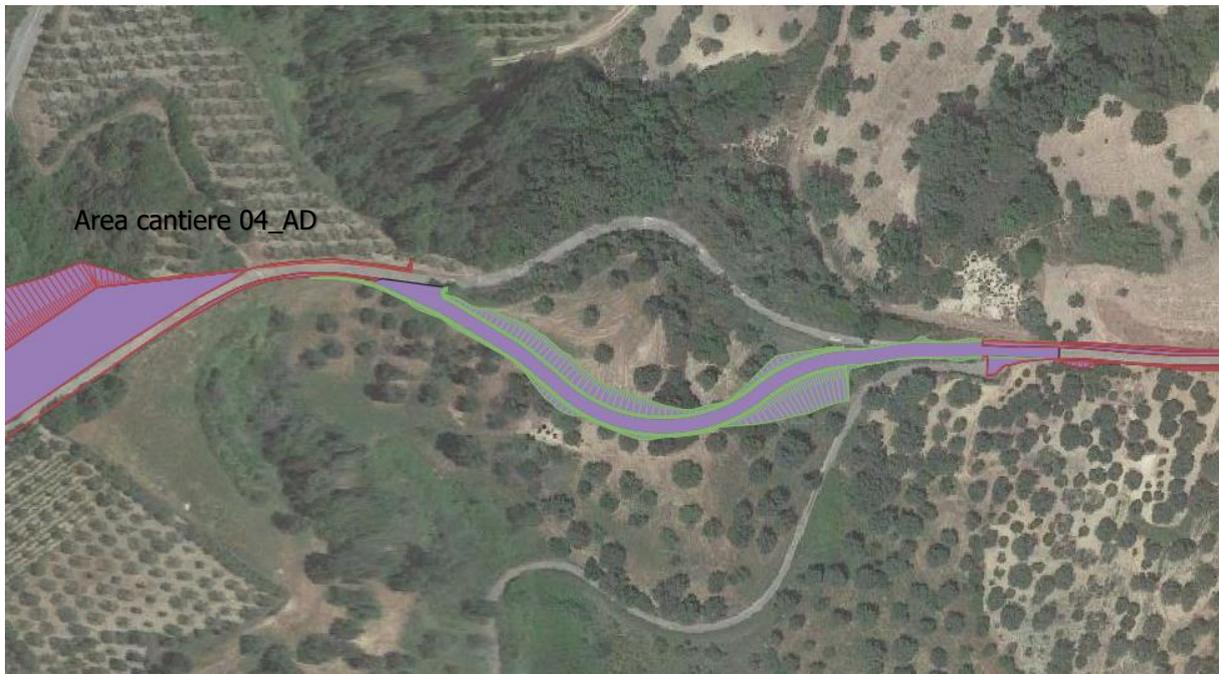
Nuovo tratto stradale in variante alla strada c.da commessa
